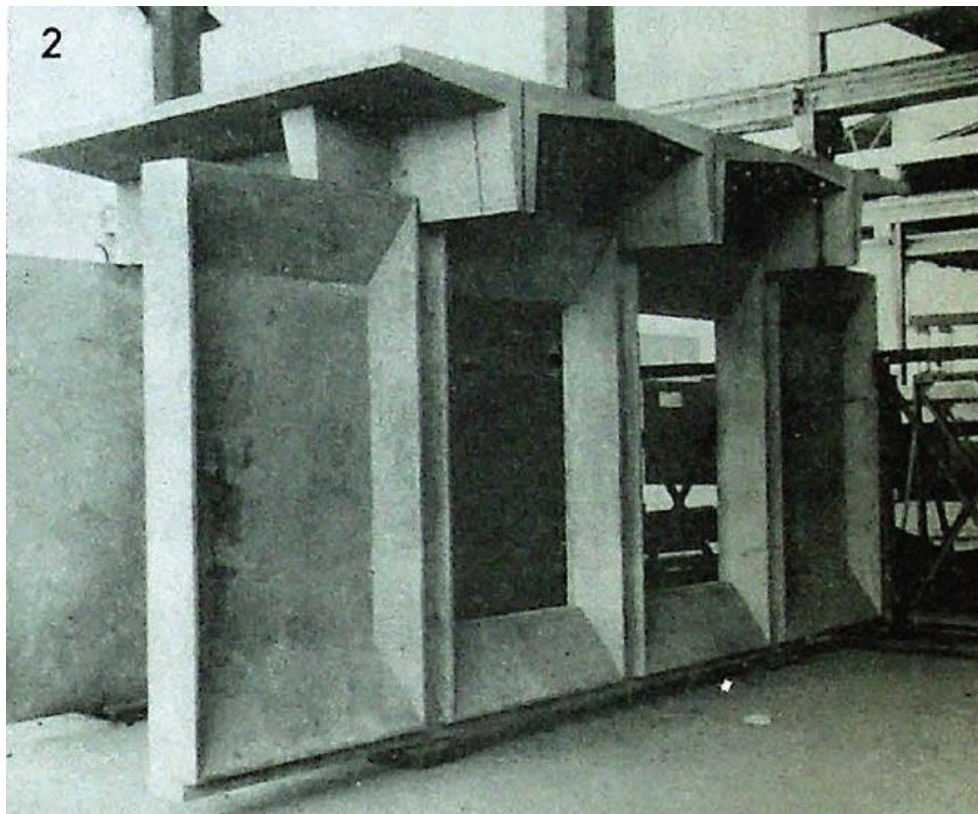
Protótipo realizado na FAPREMO do encaixe das vigas com seção "T" nos painéis-paredes estruturais e de vedação do R3. Fonte: Bruna (1972, p.77).
